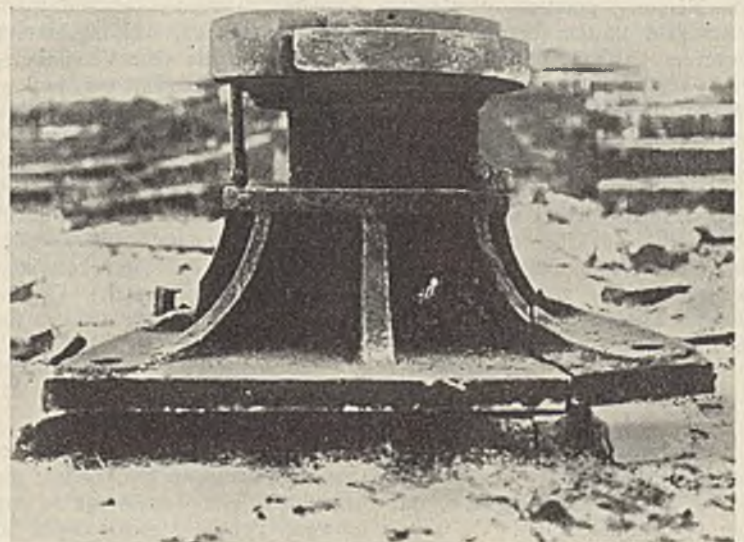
Ausgebauter Königstuhl mit gebrochener Grundplatte. Seitenansicht.
